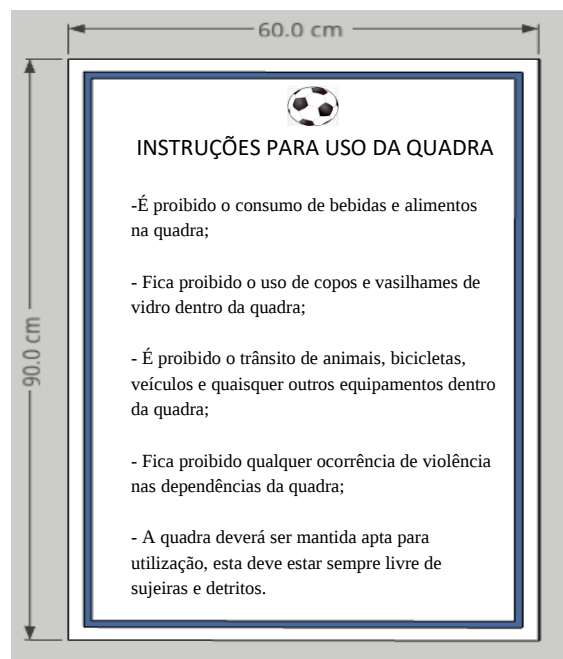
Detalhe Ilustrativo de placa de instruções (Fonte: Autor/2024)
